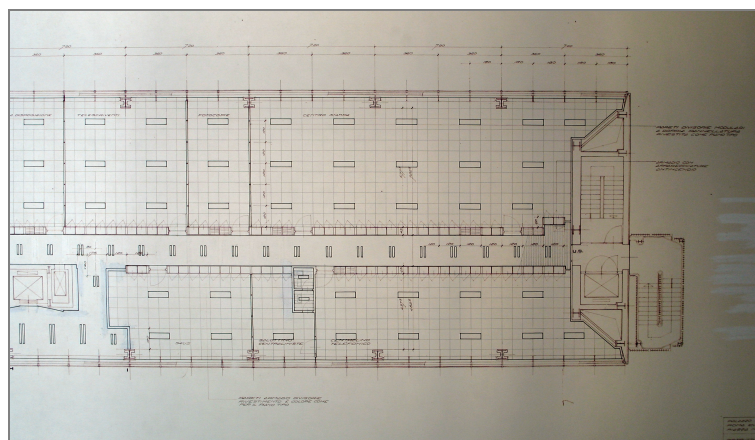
proposta di ristrutturazione generale – pianta piano primo – controsoffitto e disposizione lampade (fonte CSAC , stralcio tav. 13, archivio n. 371-2)
